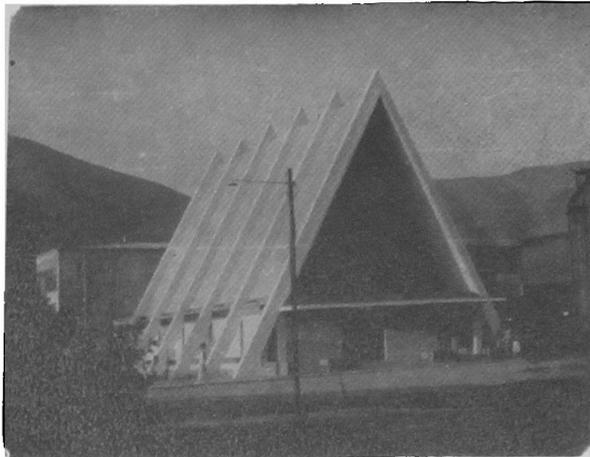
Iglesia de Llay-Llav. Daños en muros laterales de albañilería y en pilares verticales laterales. Gran destrucción de vidrios en fachada
